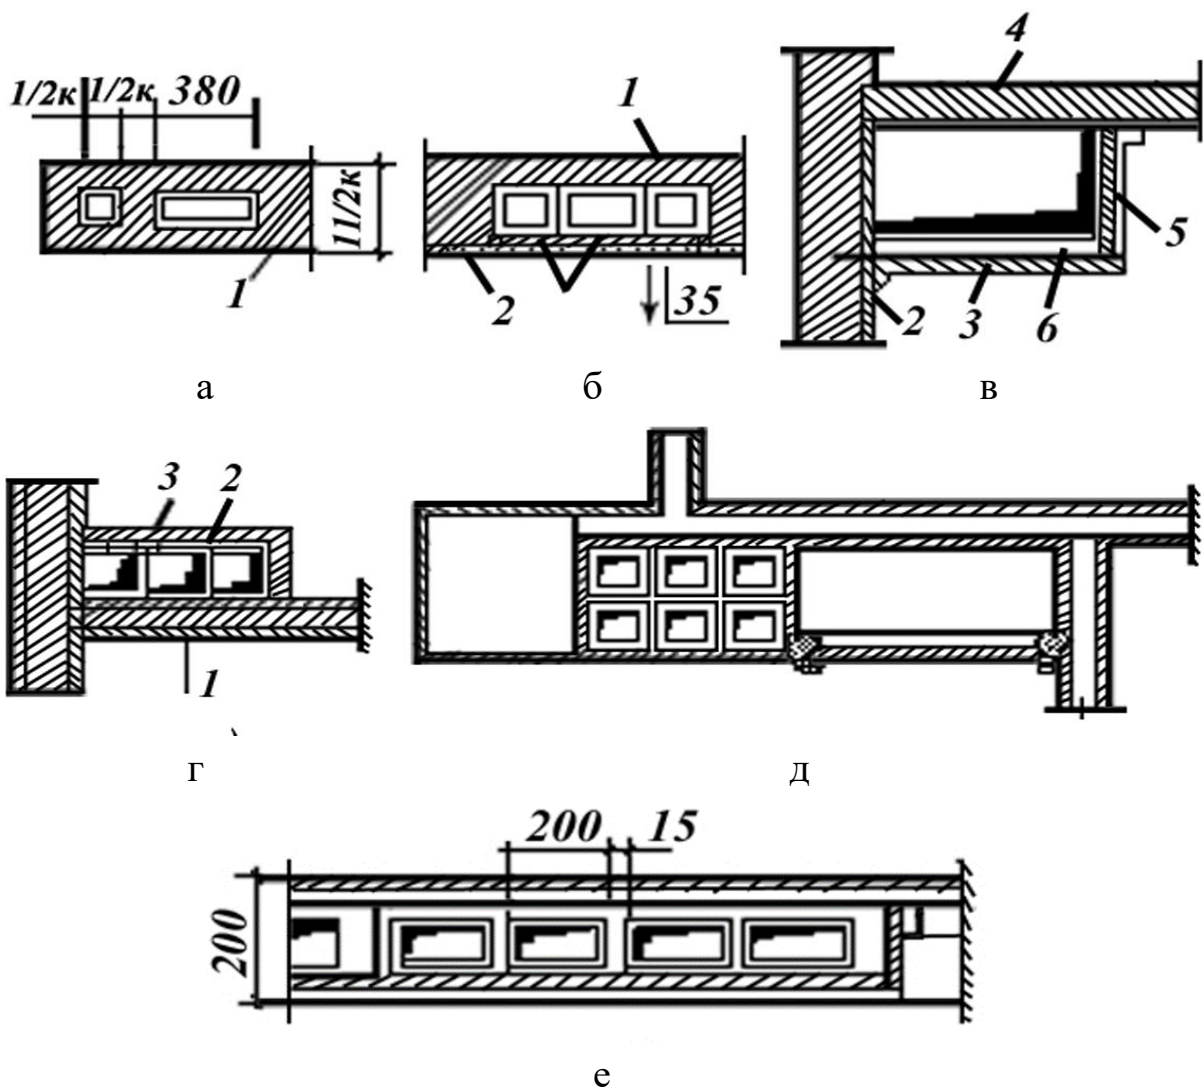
Конструкції вентиляційних каналів і повітропроводів:
